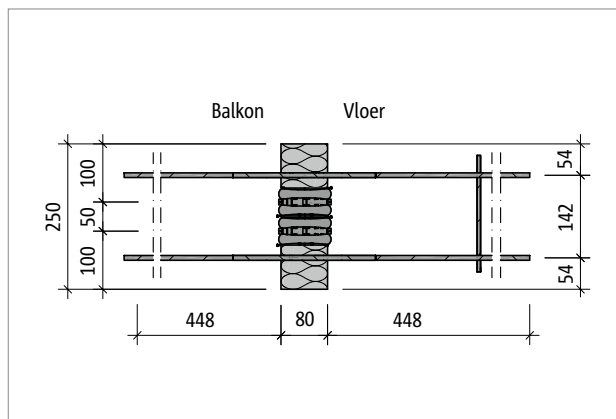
Schöck Isokorf® T type Q-E-V5: Doorsnede
